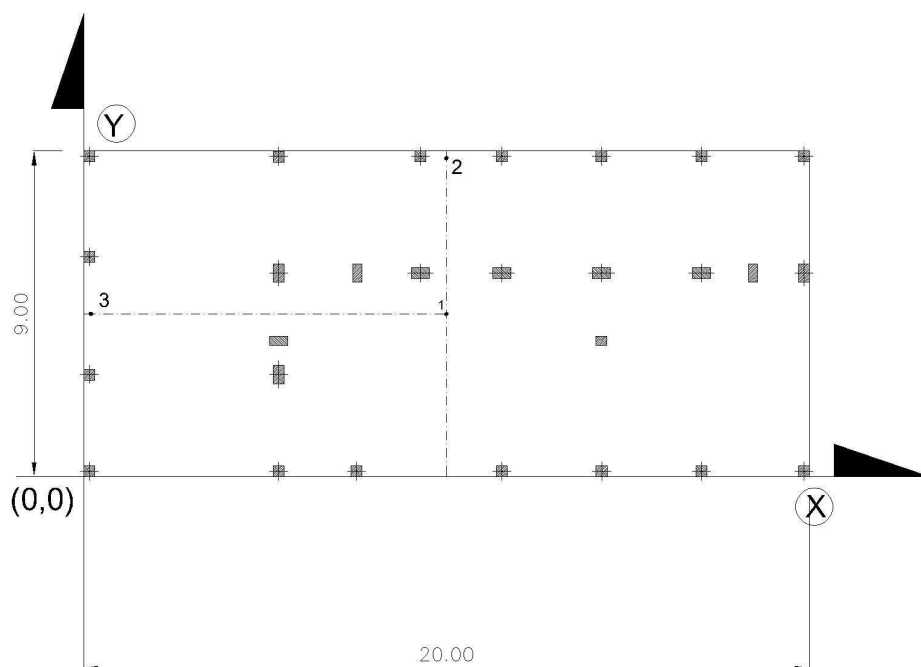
edificio servizi – planimetria direttrici di calcolo
